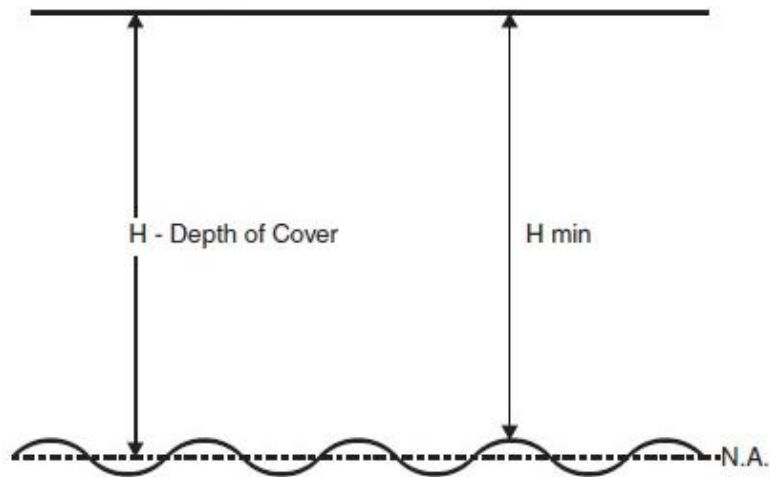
Altura de recubrimiento para estructuras suelo-metal. Fuente: Handbook of Steel Drainage & Highway Construction Products (2007)
